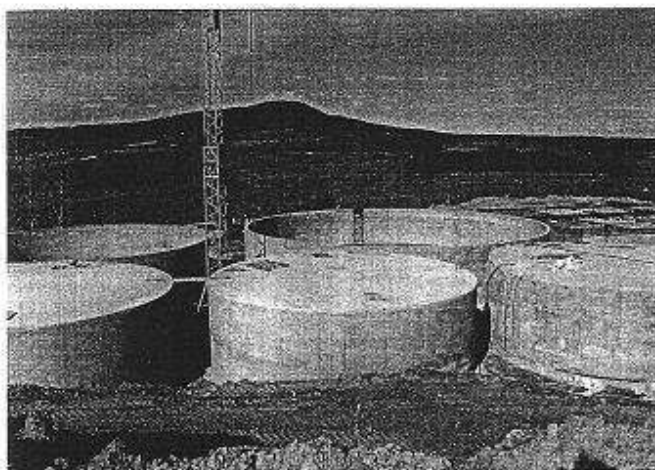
Dermbach: rohbaufertige Stahlbetonbehälter, im Vordergrund die drei Fermenter mit Betondecke (je 1.000 m³), im Hintergrund Nachgärbehälter (2.000 m³) und Endlager (4.000 m³)
